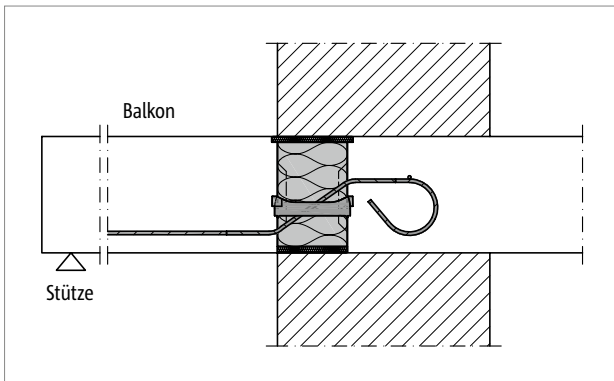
Schöck Isokorb® XT Typ QL: Anschluss bei einschaligem, wärmedämmendem Mauerwerk (XT Typ QL-V1 bis V4)
